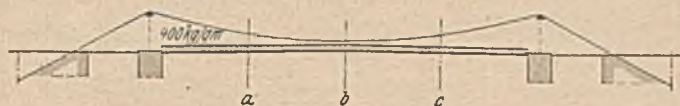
Probelastung mit ruhender Last (auf der ganzen Brücke).
